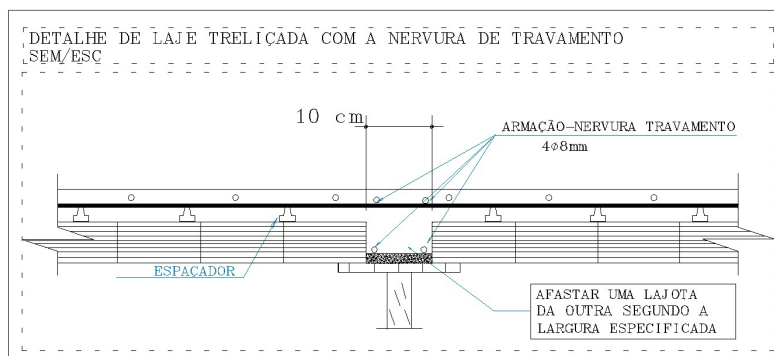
Detalhe típico das lajes treliçadas com a nervura.
